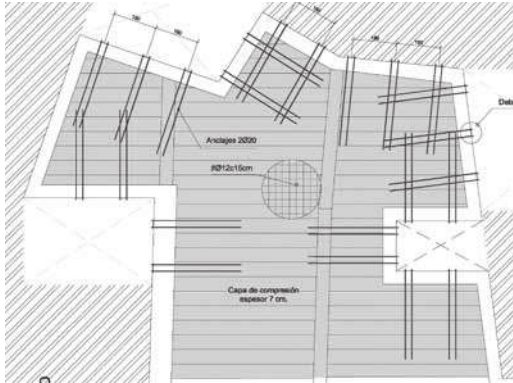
Detalle del anclaje de muro medianero a los forjados de las diferentes plantas [1].
